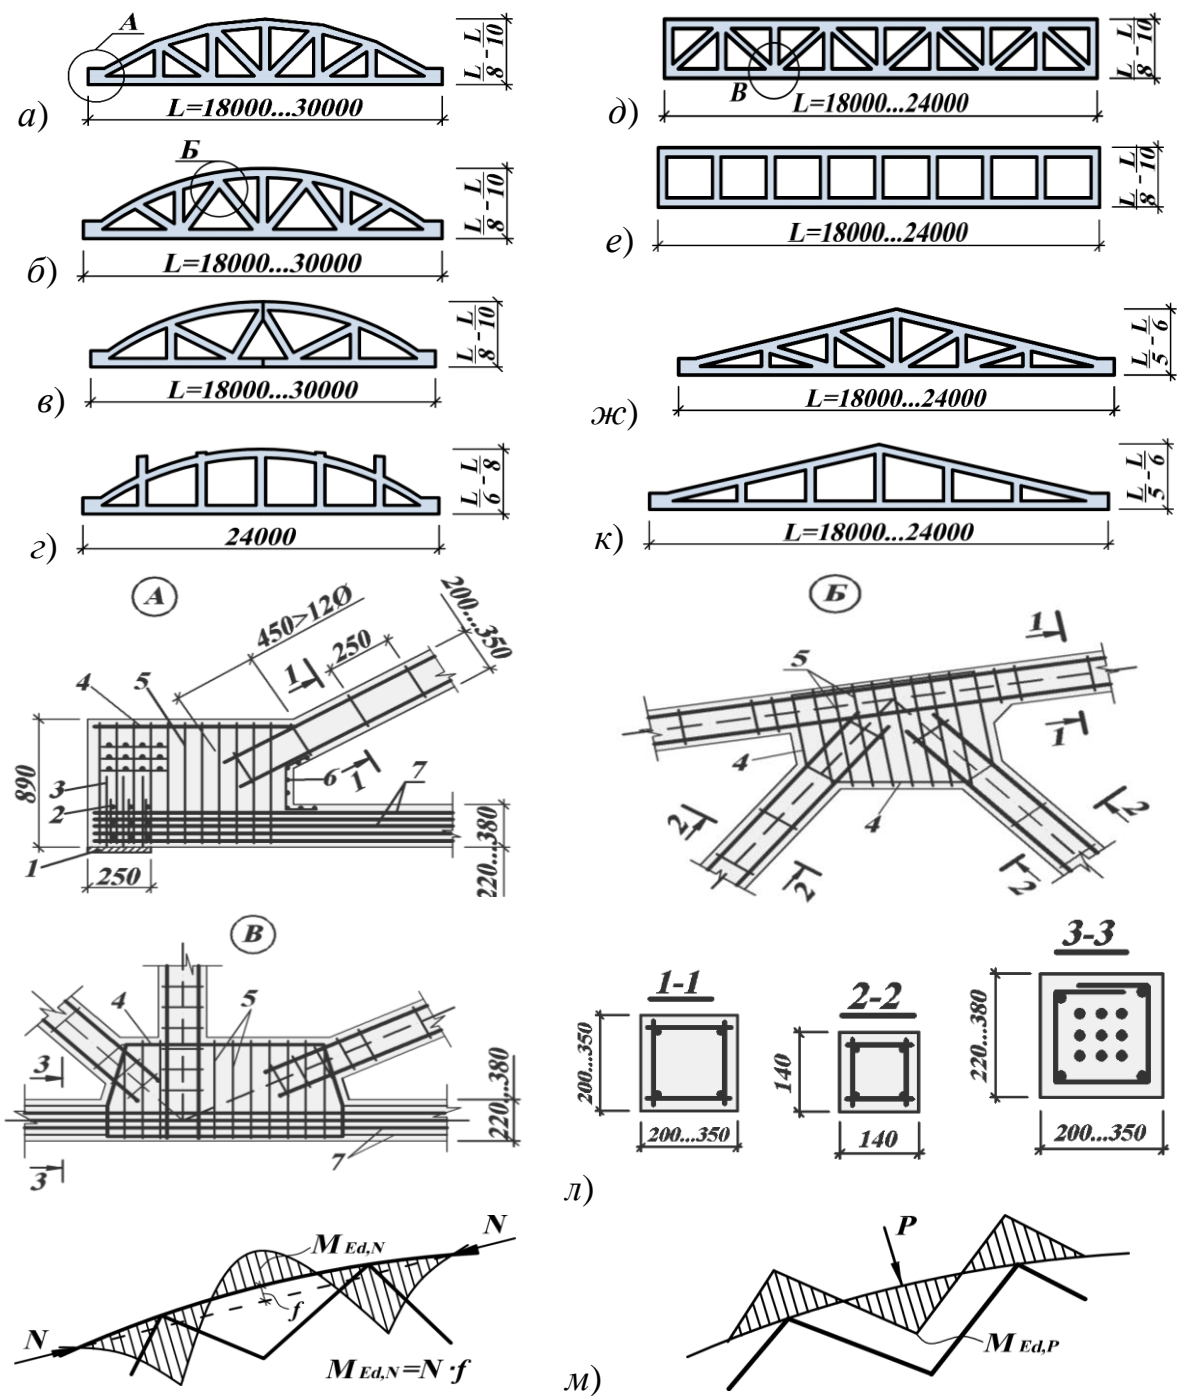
Конструкції залізобетонних крокв'яних ферм:
